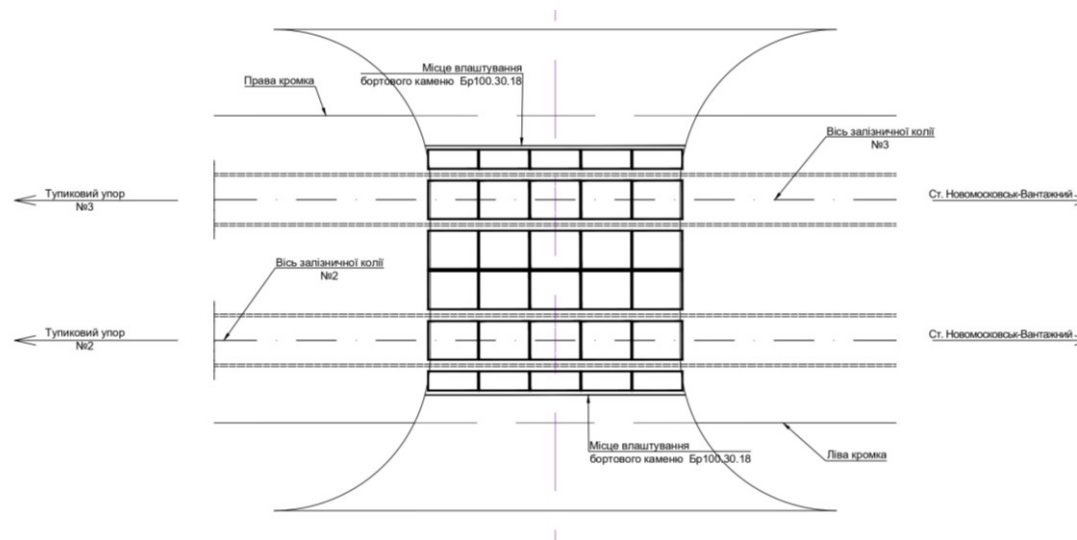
Схема розкладки плит переїзного настилу
